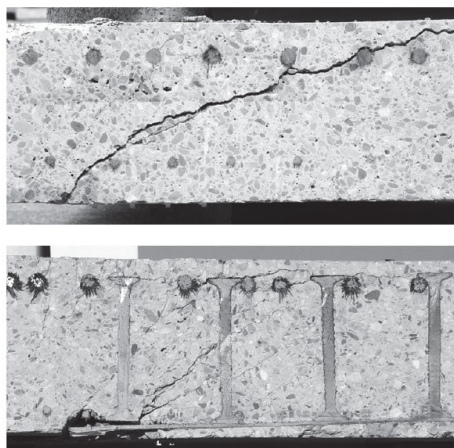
Cortes de lajes ensaiadas à punção ([EINPAUL, 2016](#))
